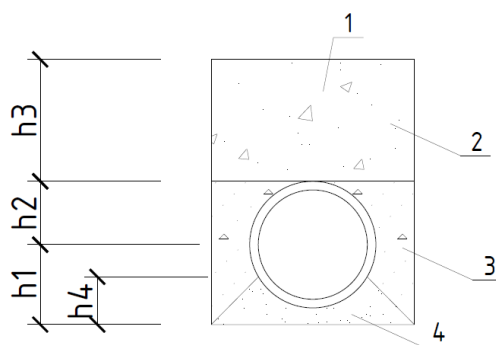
Схема уплотнения грунта вокруг трубопровода из ПВХ
